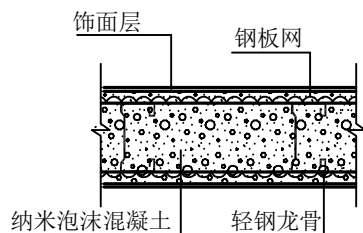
网模纳米泡沫混凝土内隔墙体基本构造示意
